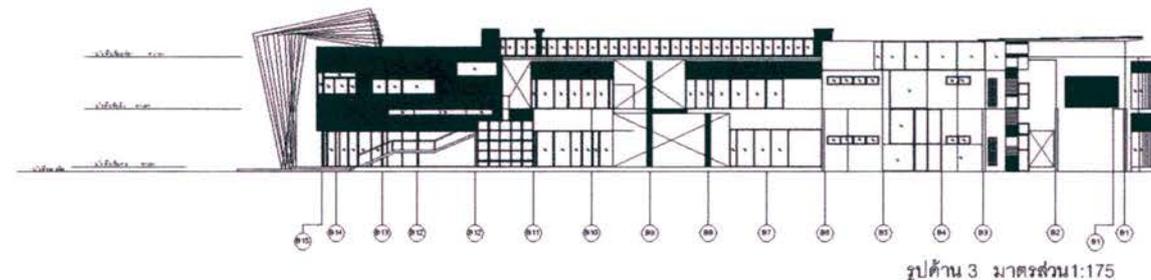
แสดงภาพ ELEVATION A
